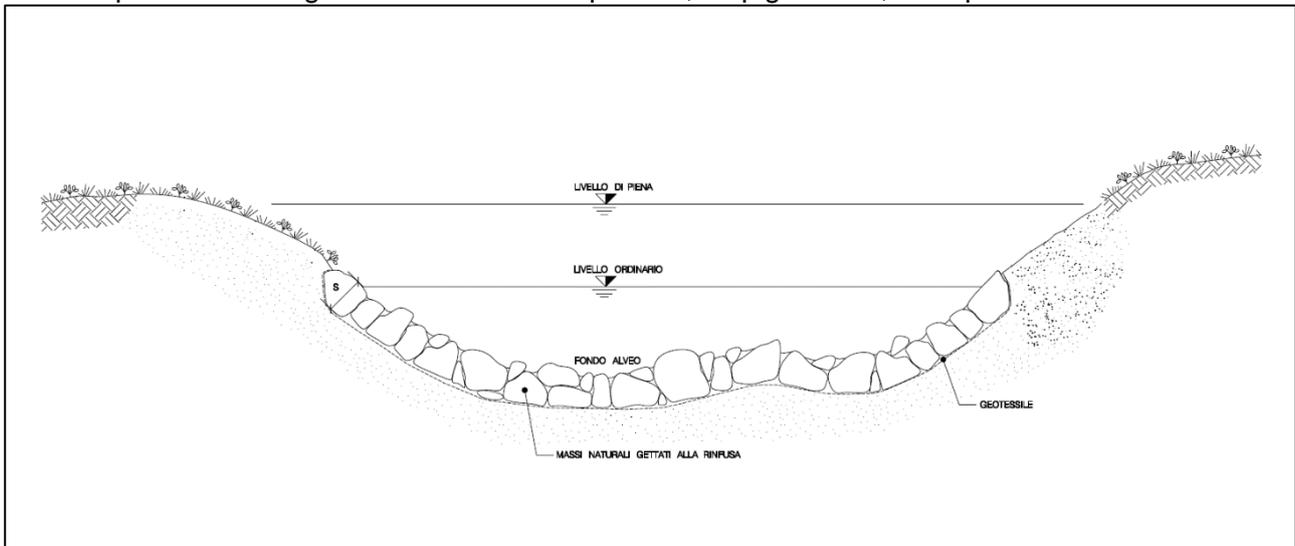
/B – Schema ricostruzione dell'alveo con massi
